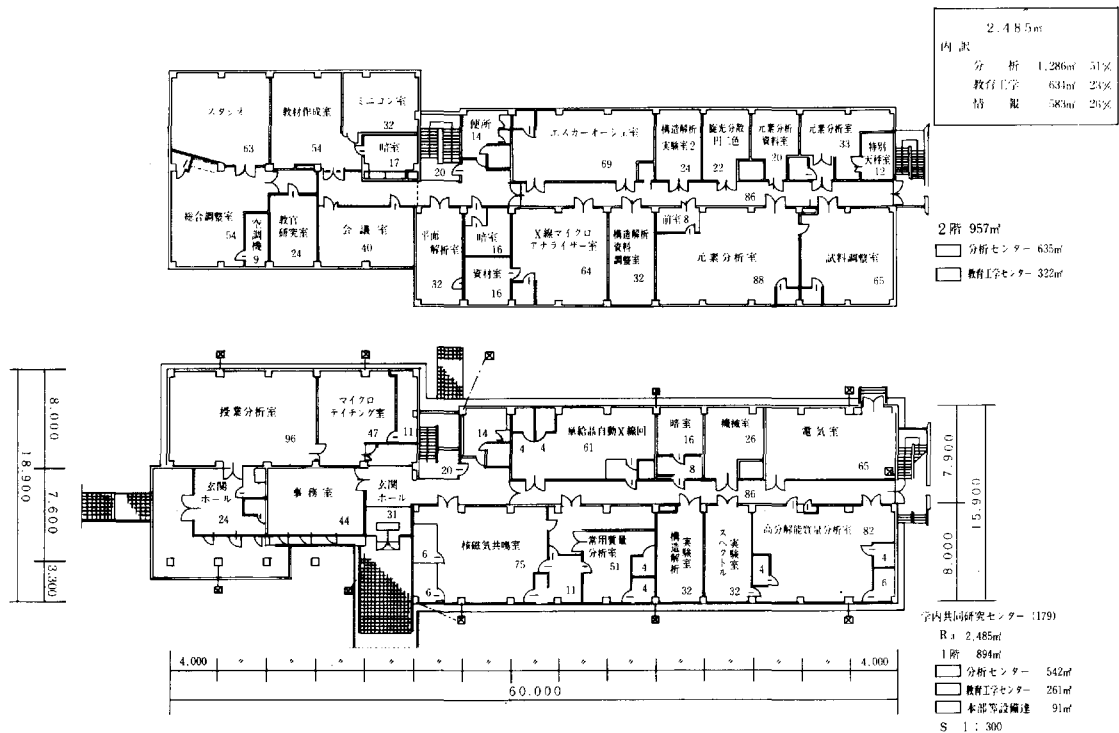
千葉大学「共同研究センター」1,2階の平面図と分析機器等の配置図
